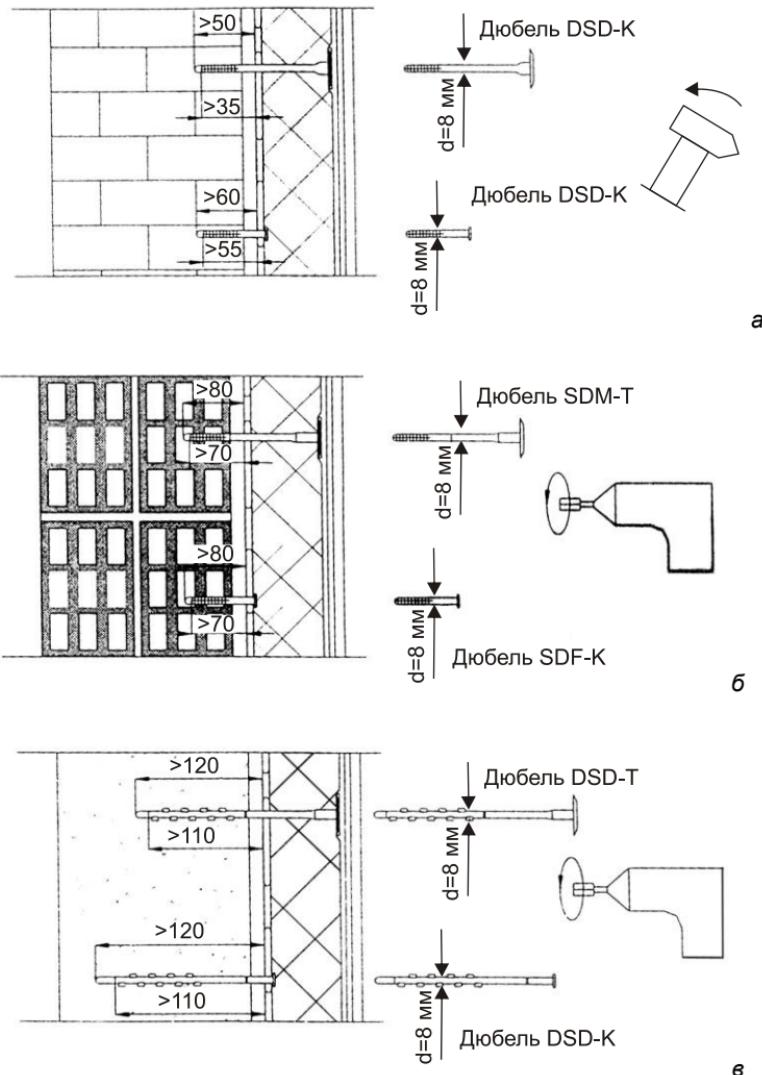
Крепление дюбелями плит FAÇADE BATTs и FAÇADE SLAB: а — основание: полнотелый кирпич, бетон; б — основание: щелевой кирпич, керамзитобетон; в — основание: пено-, газобетон
